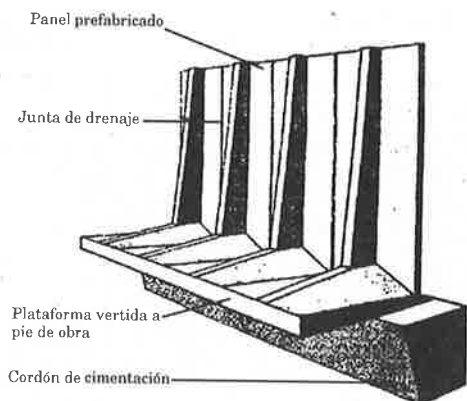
Muro de hormigón prefabricado de pared vertical, altura hasta 4 - 5 m
